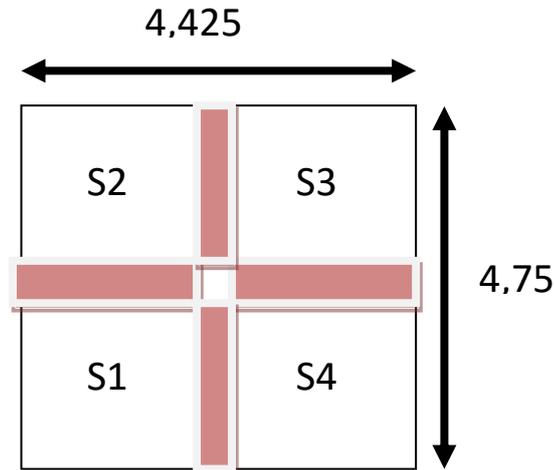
La section la plus sollicité du poteau rectangulaire.
